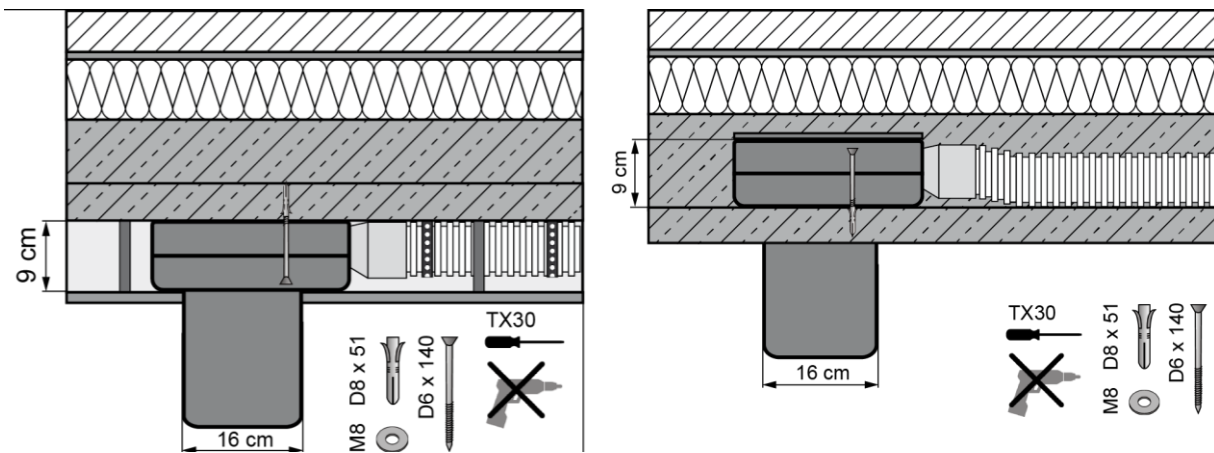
Montage in abgehängter Decke und Rohbetondecke
